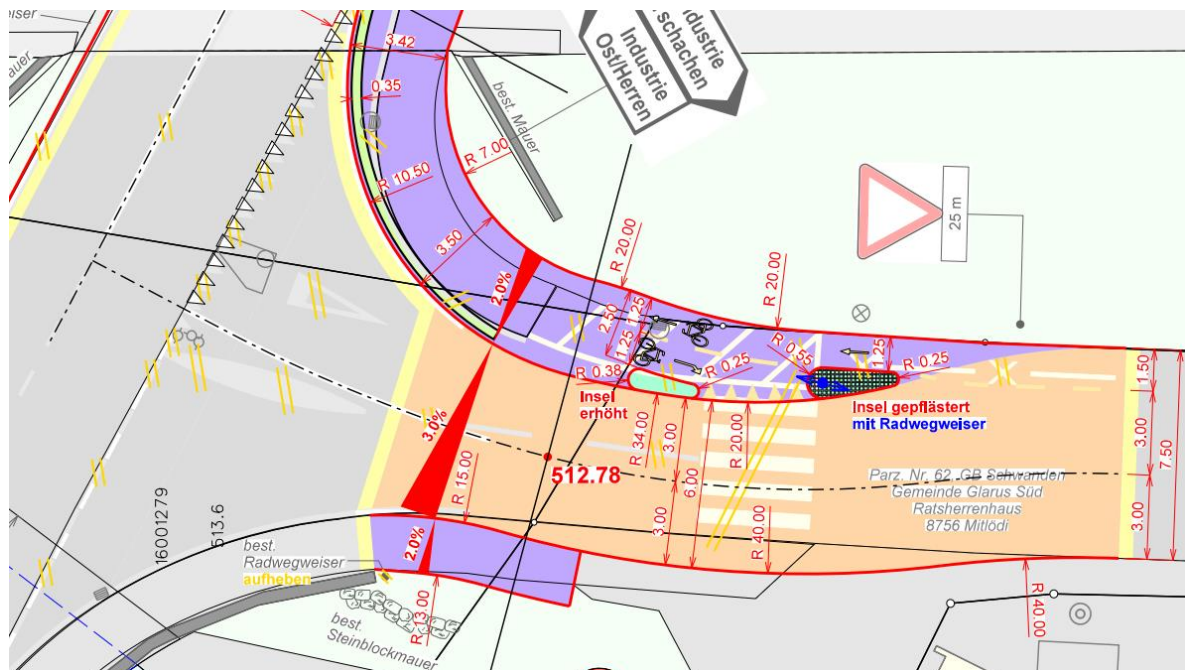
Situationsplan Querung Tschachenstrasse
